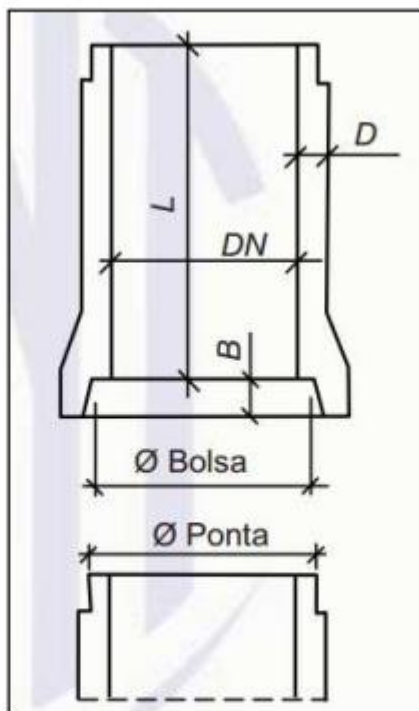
Corte longitudinal típico de tubo com encaixe ponta e bolsa.
